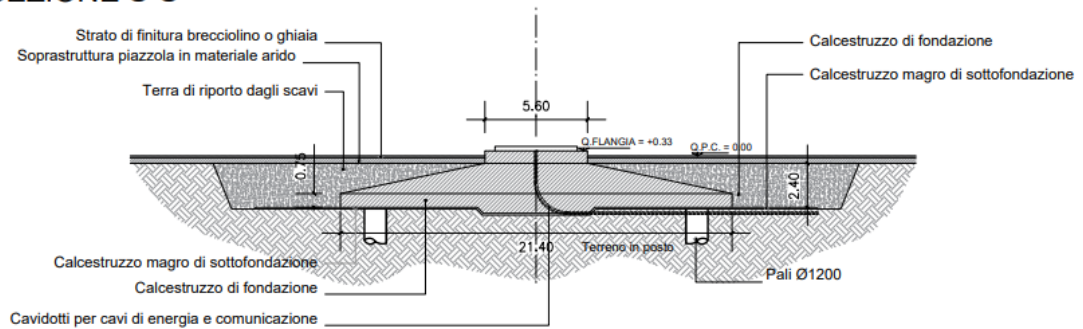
Dettaglio sezione basamento di fondazione in progetto torre tipologia V136
